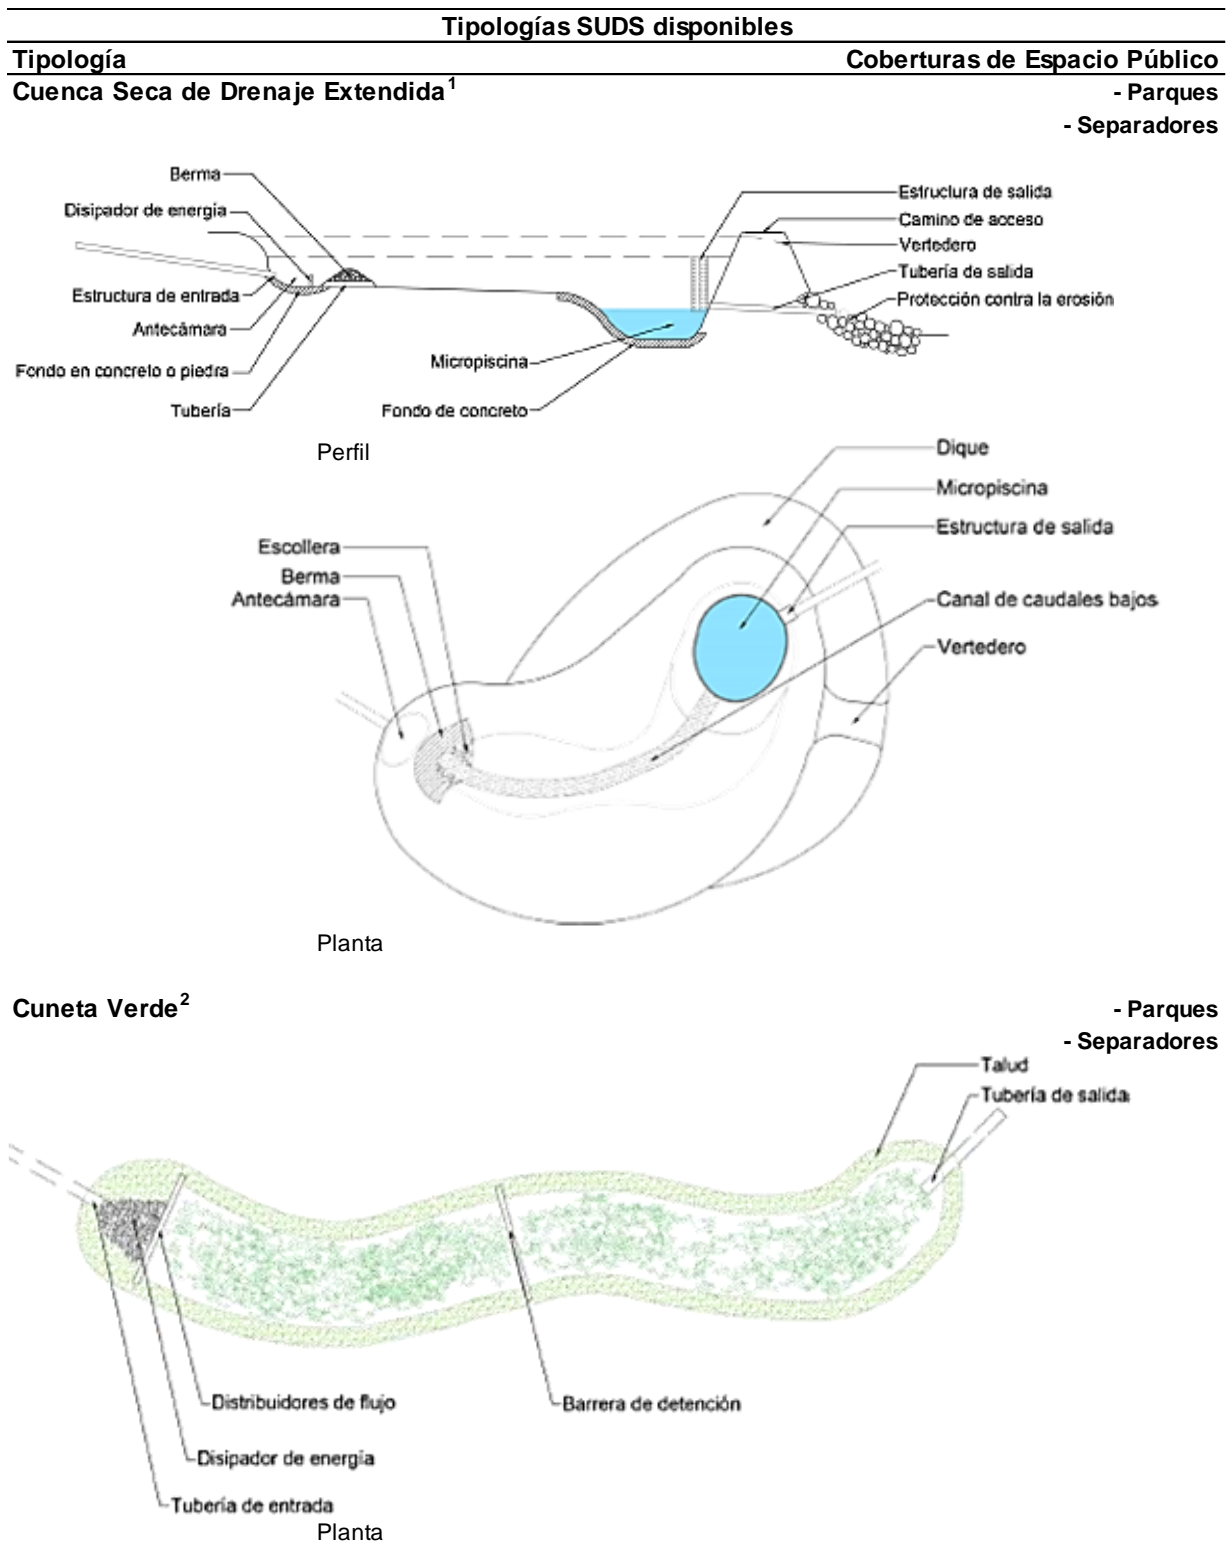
Tipologías SUDS disponibles (Cuneta seca de drenaje extendido, Cuneta verde)
